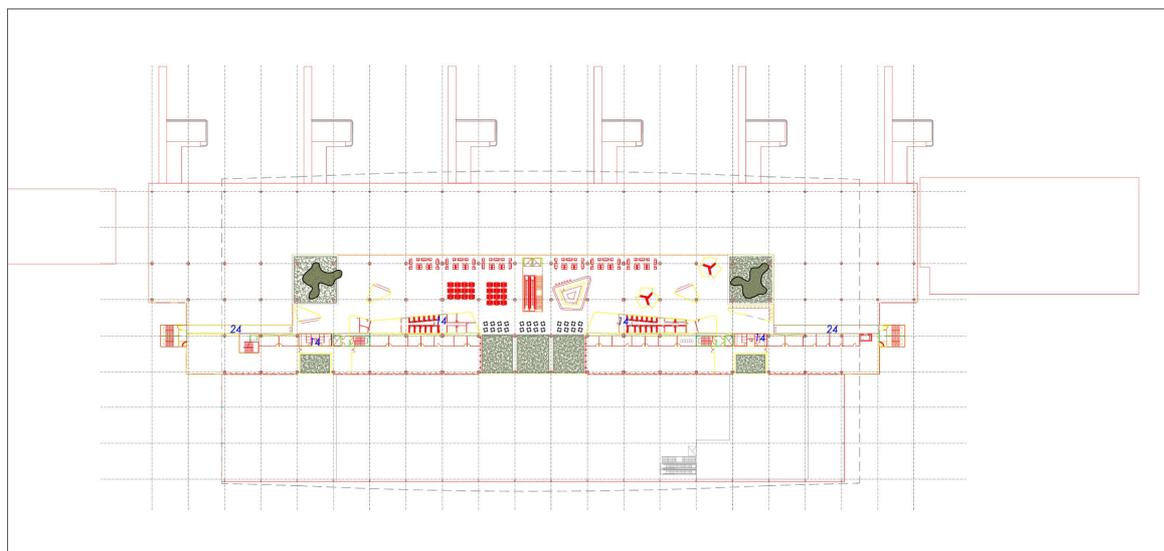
NUOVO TERMINAL – Pianta Piano Secondo scala originale 1/500
